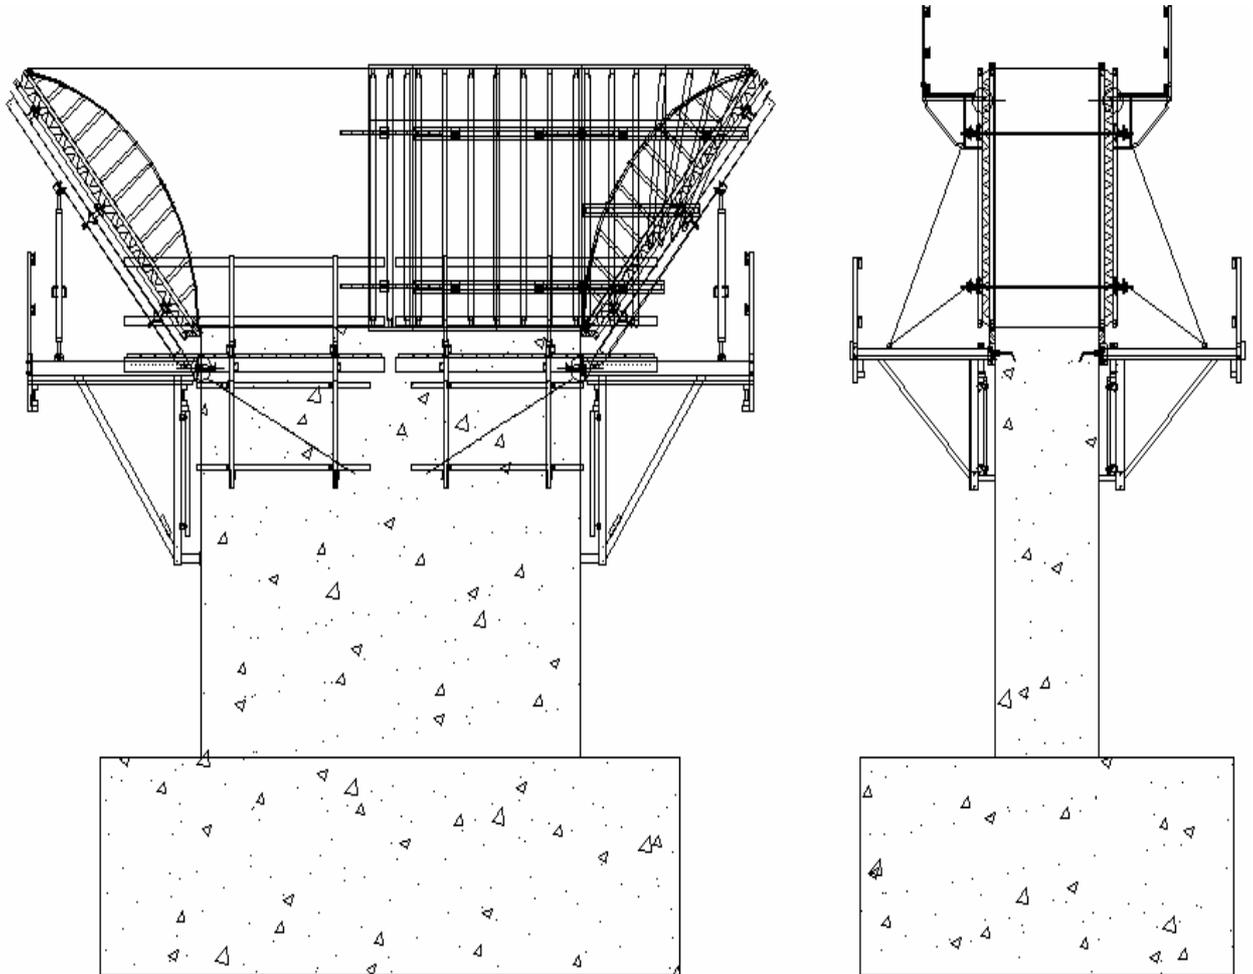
Tampak depan dan Samping Formwork Pier Tahap-1
